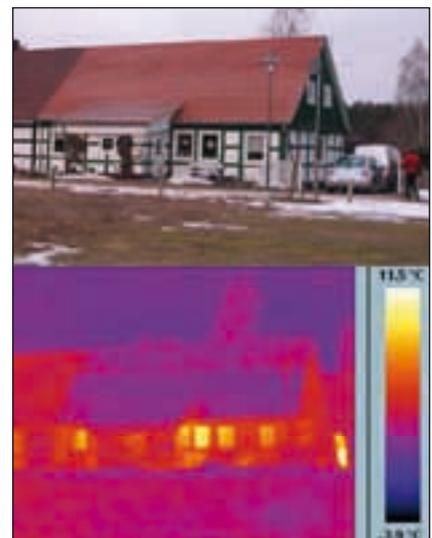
Fachwerkhaus, Baujahr ca. 1850
